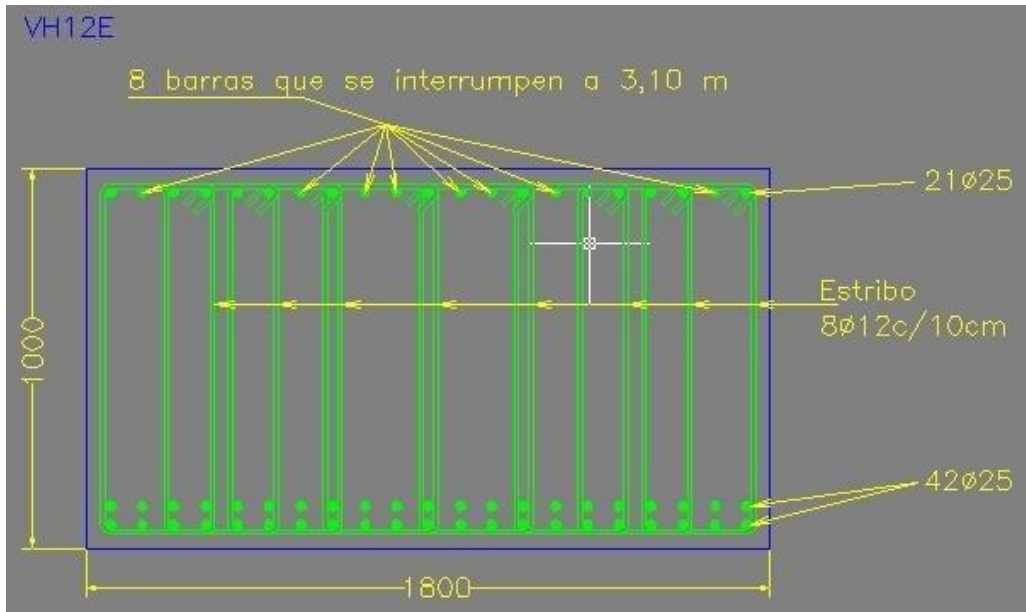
Detalle de armado e interrupción de armadura de la viga VH12E.
